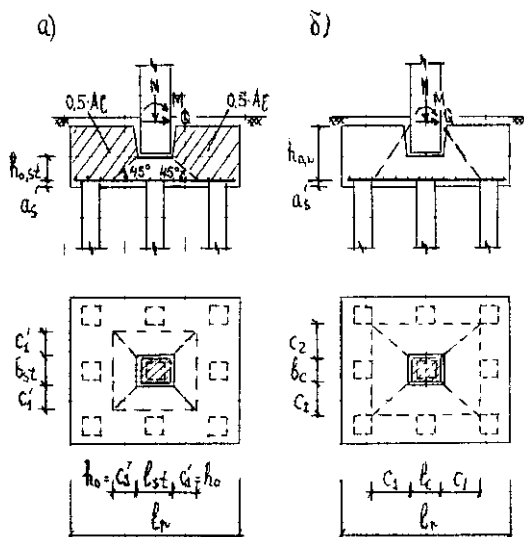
Схемы расчёта плитного ростверка: а — на раскалывание, б — на продавливание
